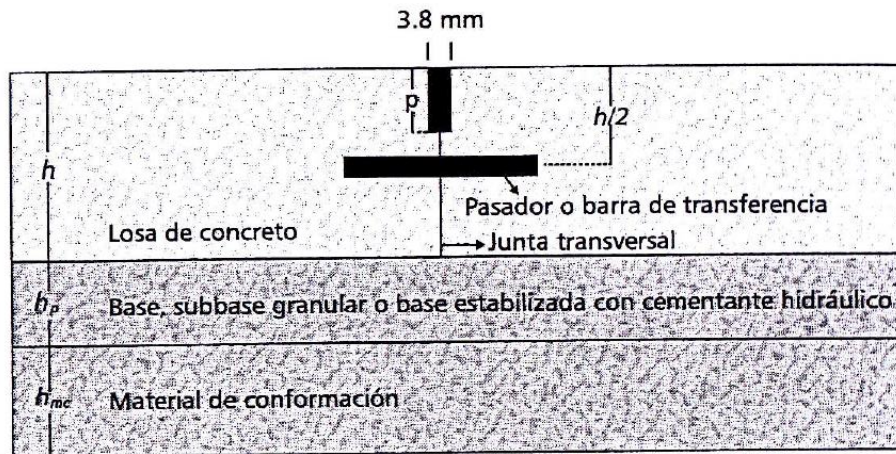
Perfil típico de una estructura de pavimento rígido con junta con pasadores.
